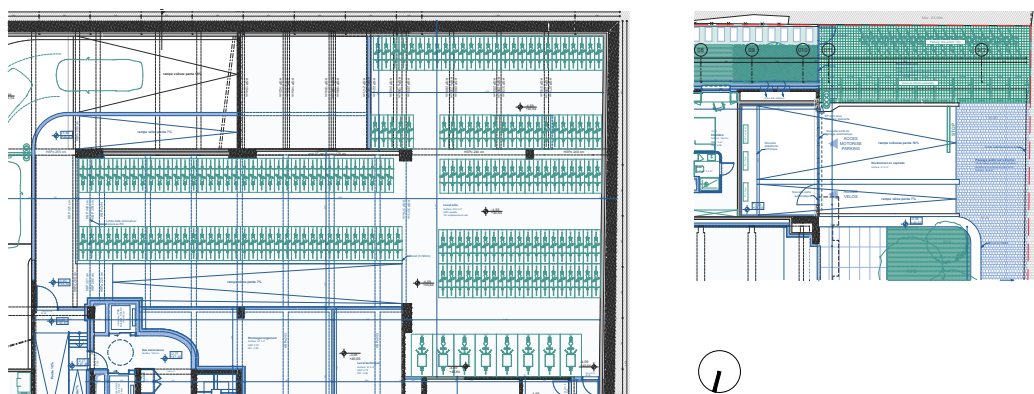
Plan niveau -1 - zoom local vélos et plan niveau 0 zoom accès depuis la rue
